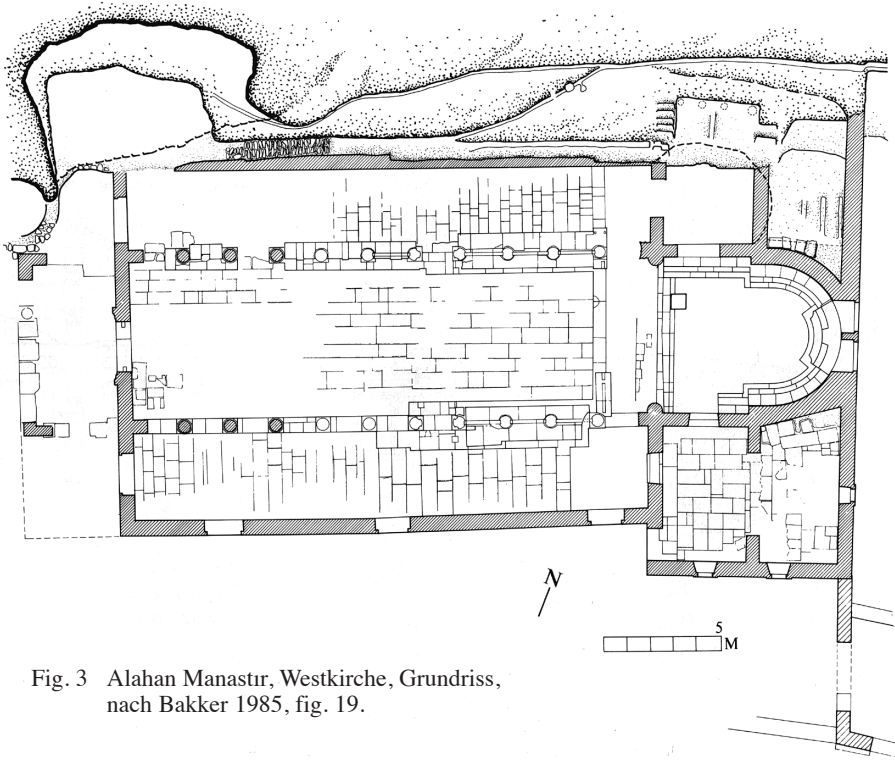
Alahan Manastir, Westkirche, Grundriss,
